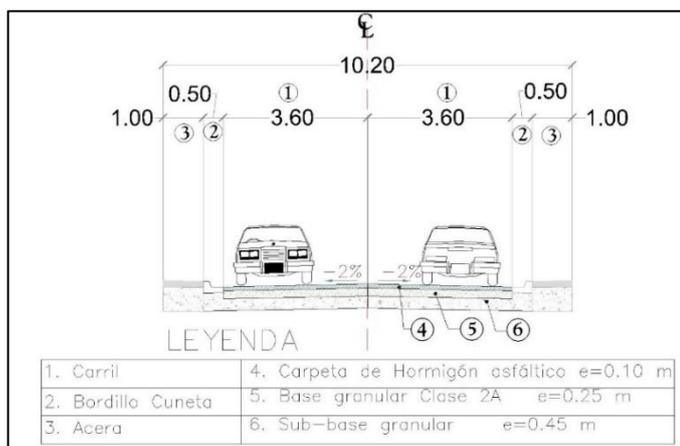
Sección Transversal Tipo 3, Alternativa 3.
